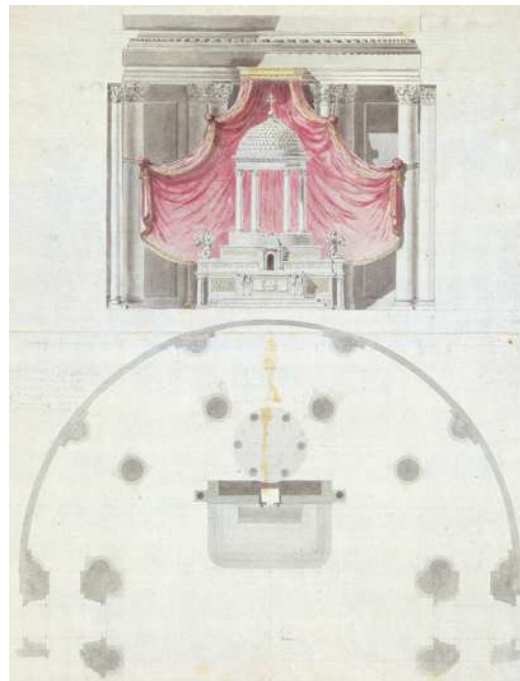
S. Cantoni, *Pianta dell'abside e progetto dell'altare*, 1805 ca
